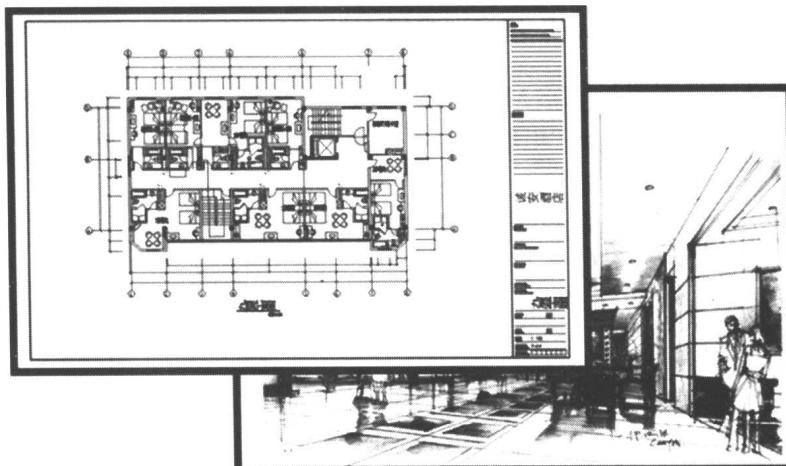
用 AutoCAD 绘制的施工图和手绘效果图示例
